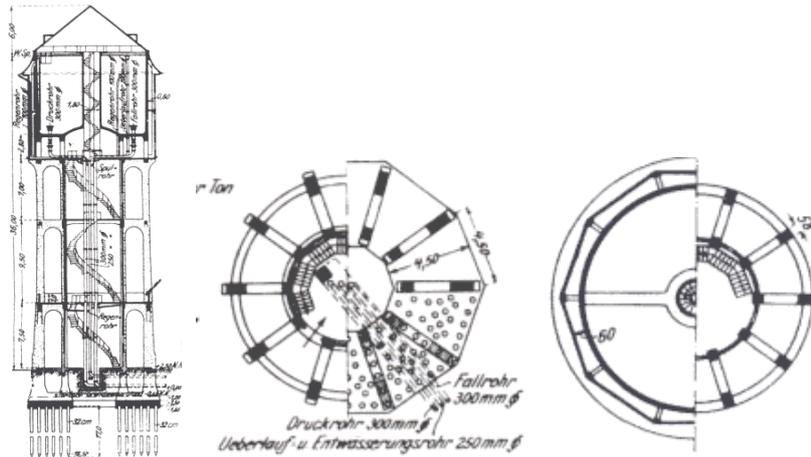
Wasserturm in Emden      Abb. 64: Wasserturm Emden, Schnitt und Grundrisse
